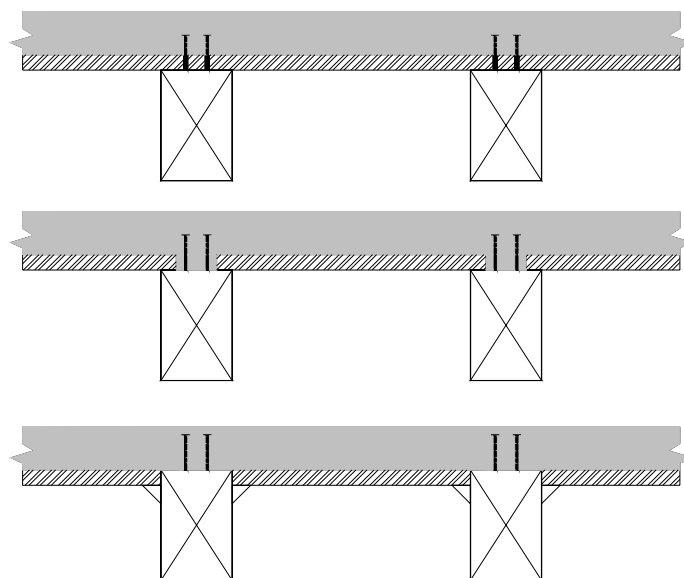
Perfis transversais tipo para situações de reabilitação e reforço de pavimentos antigos de madeira.
